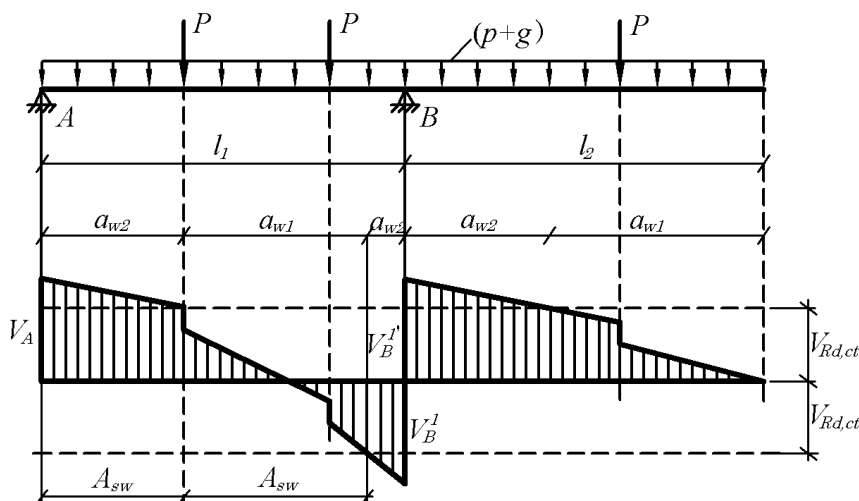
Разбиение балки на участки для расчета поперечного армирования
